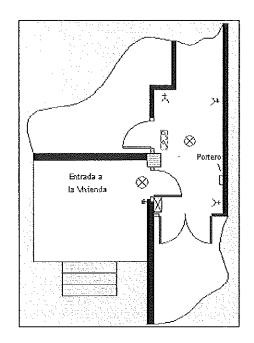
Figura D: Plano de planta del acceso de la vivienda y el vestíbulo
